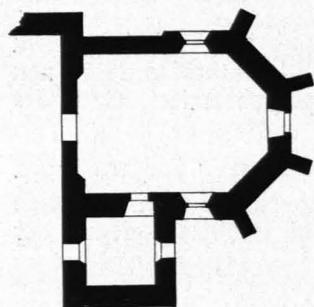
Pehendorf, Presbyterium der alten Pfarrkirche, Grundriß 1 : 300 (S. 263)
